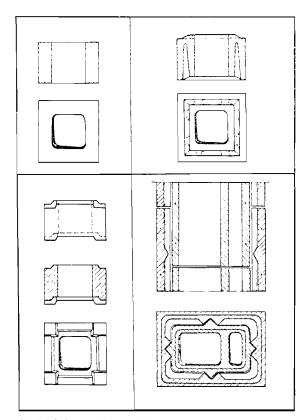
Beispiele von Schornsteinformstücken aus Leichtbeton Fig. 47. Examples of lightweight concrete chimney units Fig. 47. Exemples de pièces en béton léger pour cheminées.
